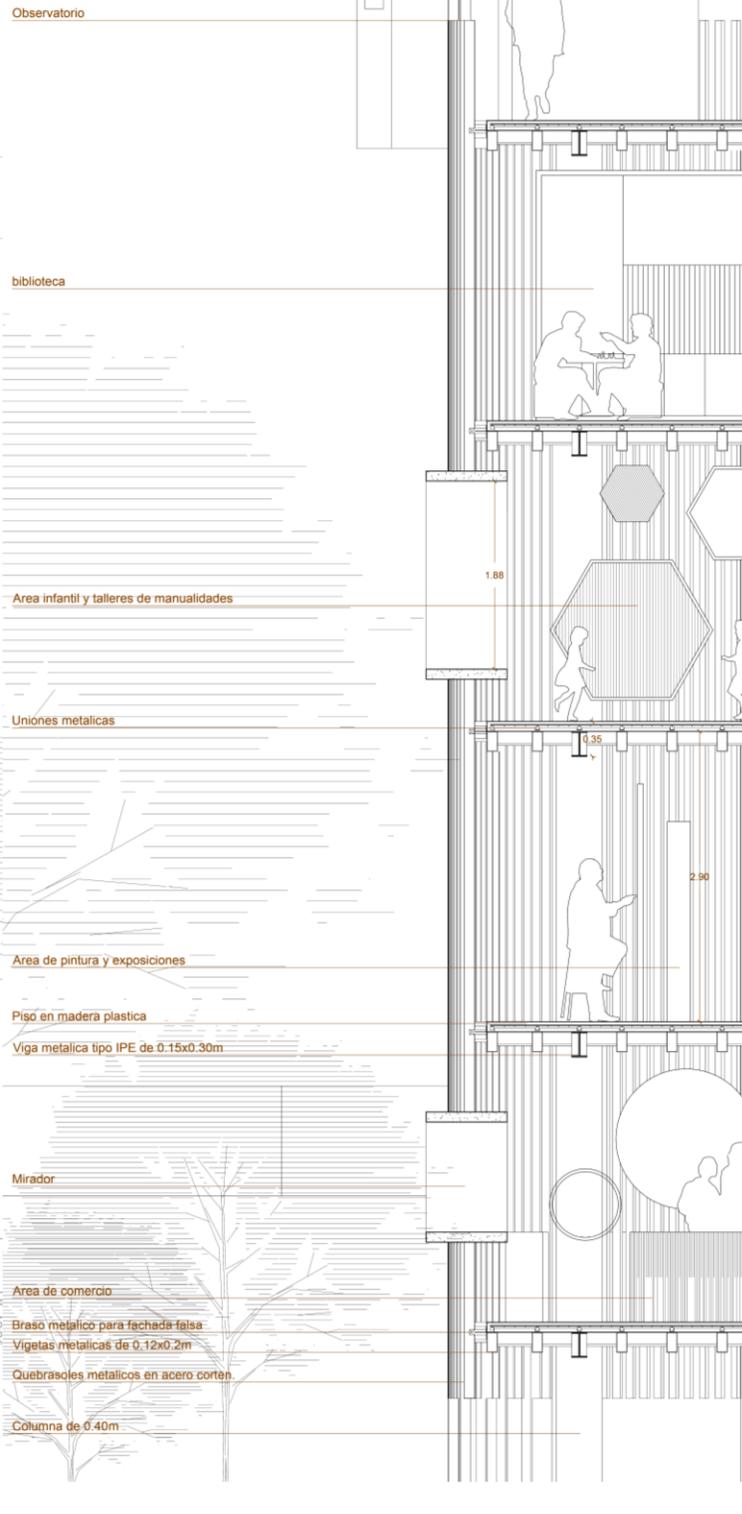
Vista – Detalles Constructivos. Fuente Propia.
